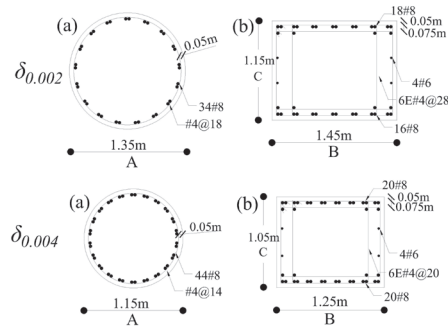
Secciones geométricas y acero de refuerzo, a) columnas y b) cabezales
